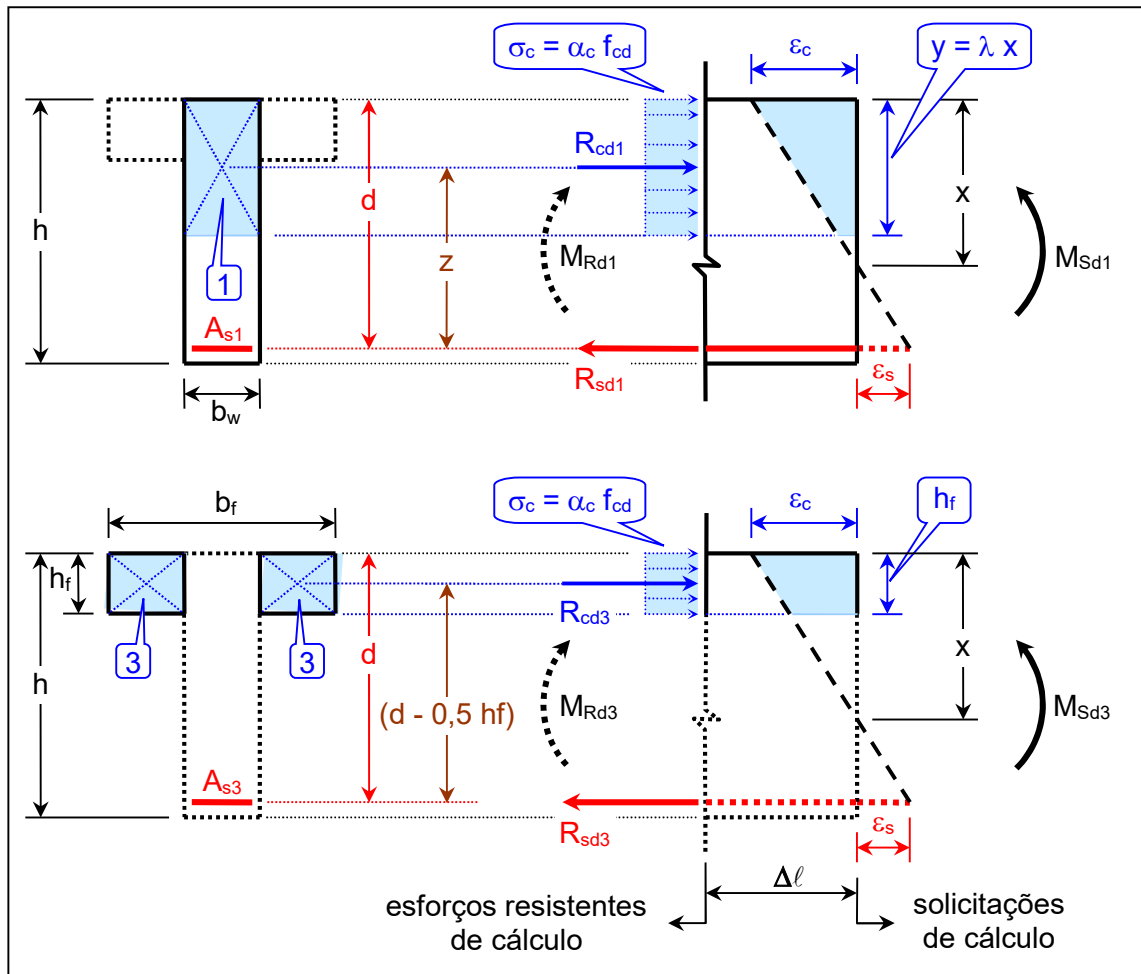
Vigas de seção T sem armadura de compressão - $y > h_f$
